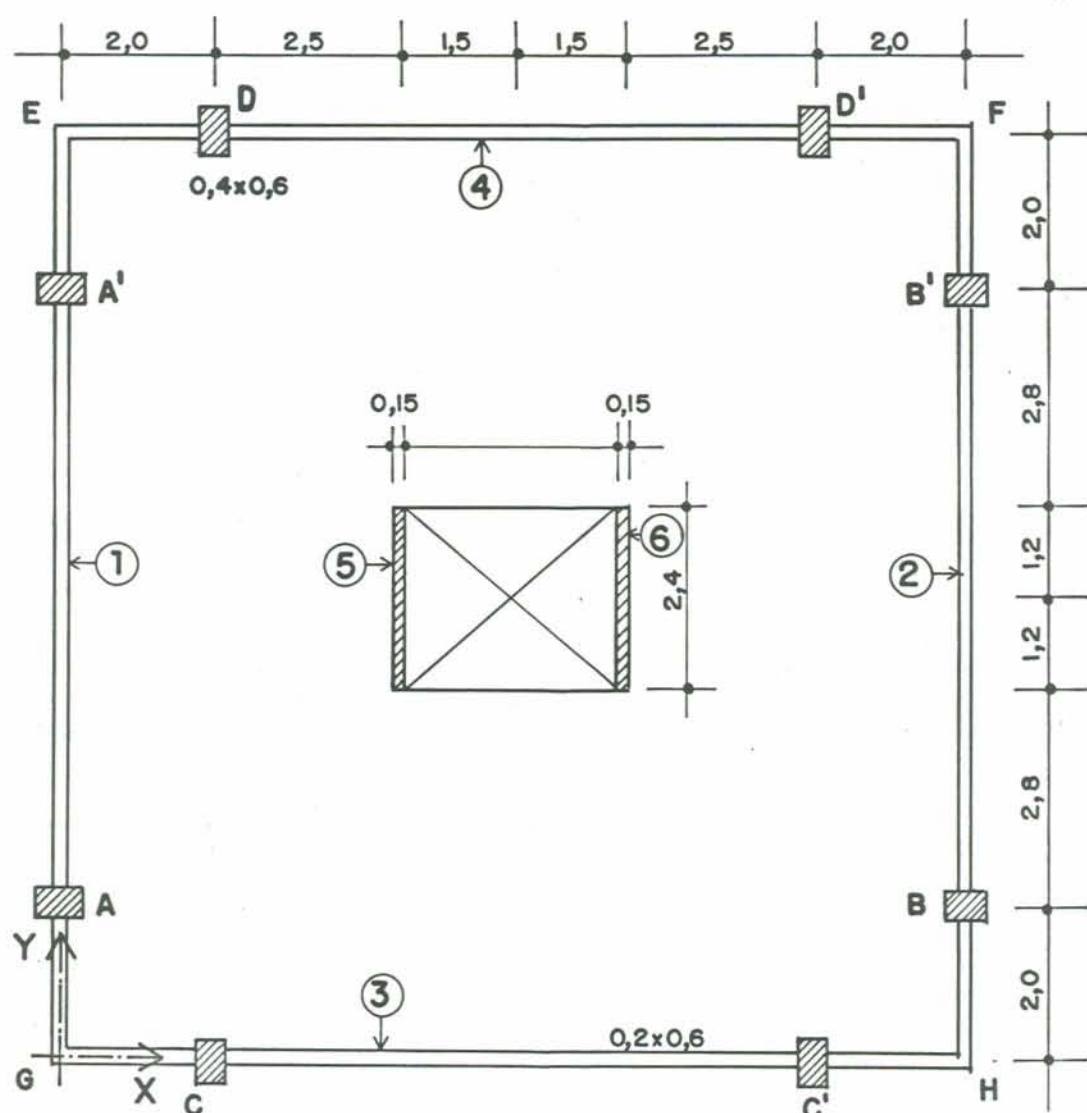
Planta baixa do exemplo 3 (medidas em m)
